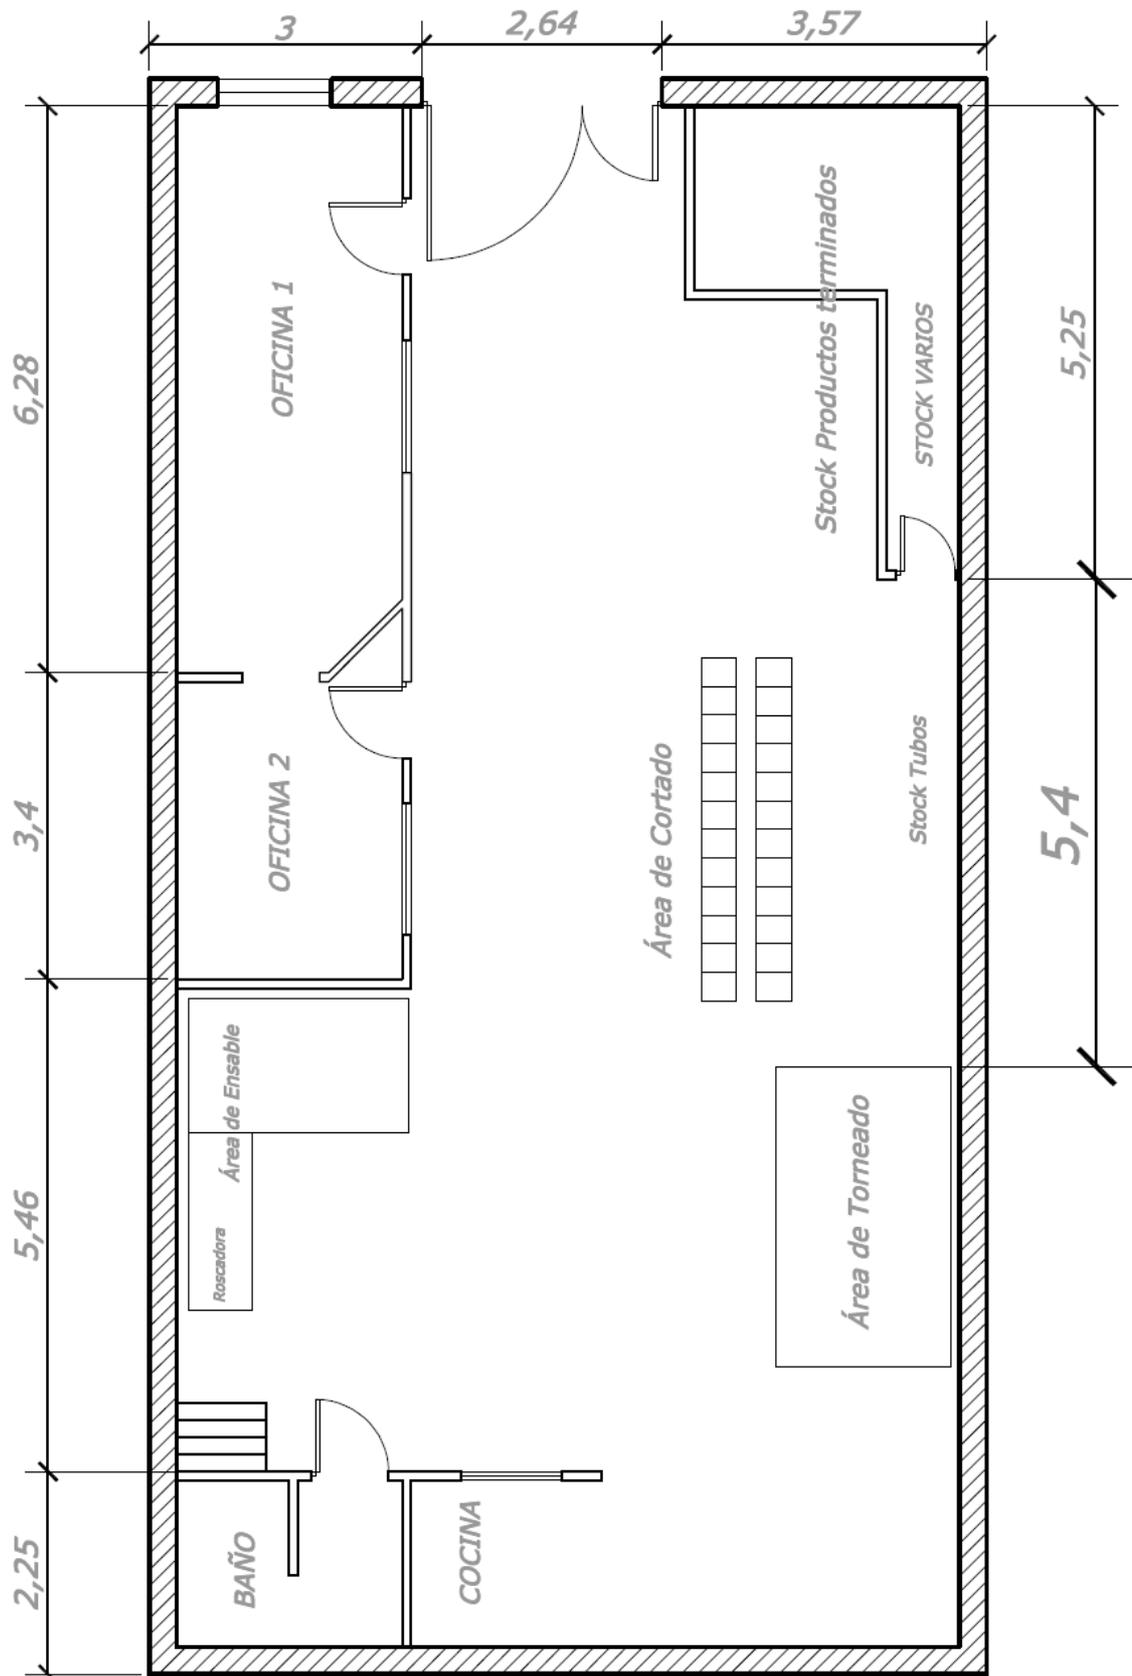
Plano Instalaciones - Fuente: Elaboración propia
